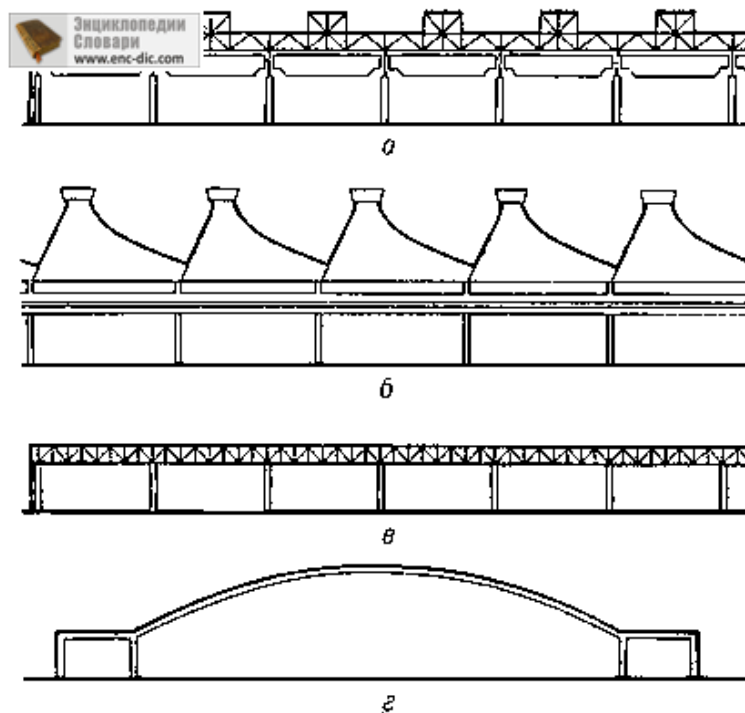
Одноэтажные промышленные здания: а — многопролетное крановое здание со световыми фонарями; б — многопролетное здание с аэрационными вытяжными шахтами ; в — многопролетное бескрановое бесфонарное здание; г — здание зального типа.
